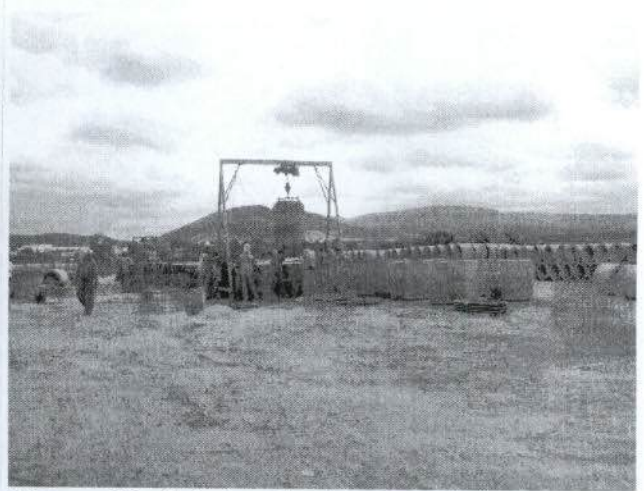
Fabricação de tubos de concreto diretamente sobre o solo acarretando na contaminação com resíduos de concreto
